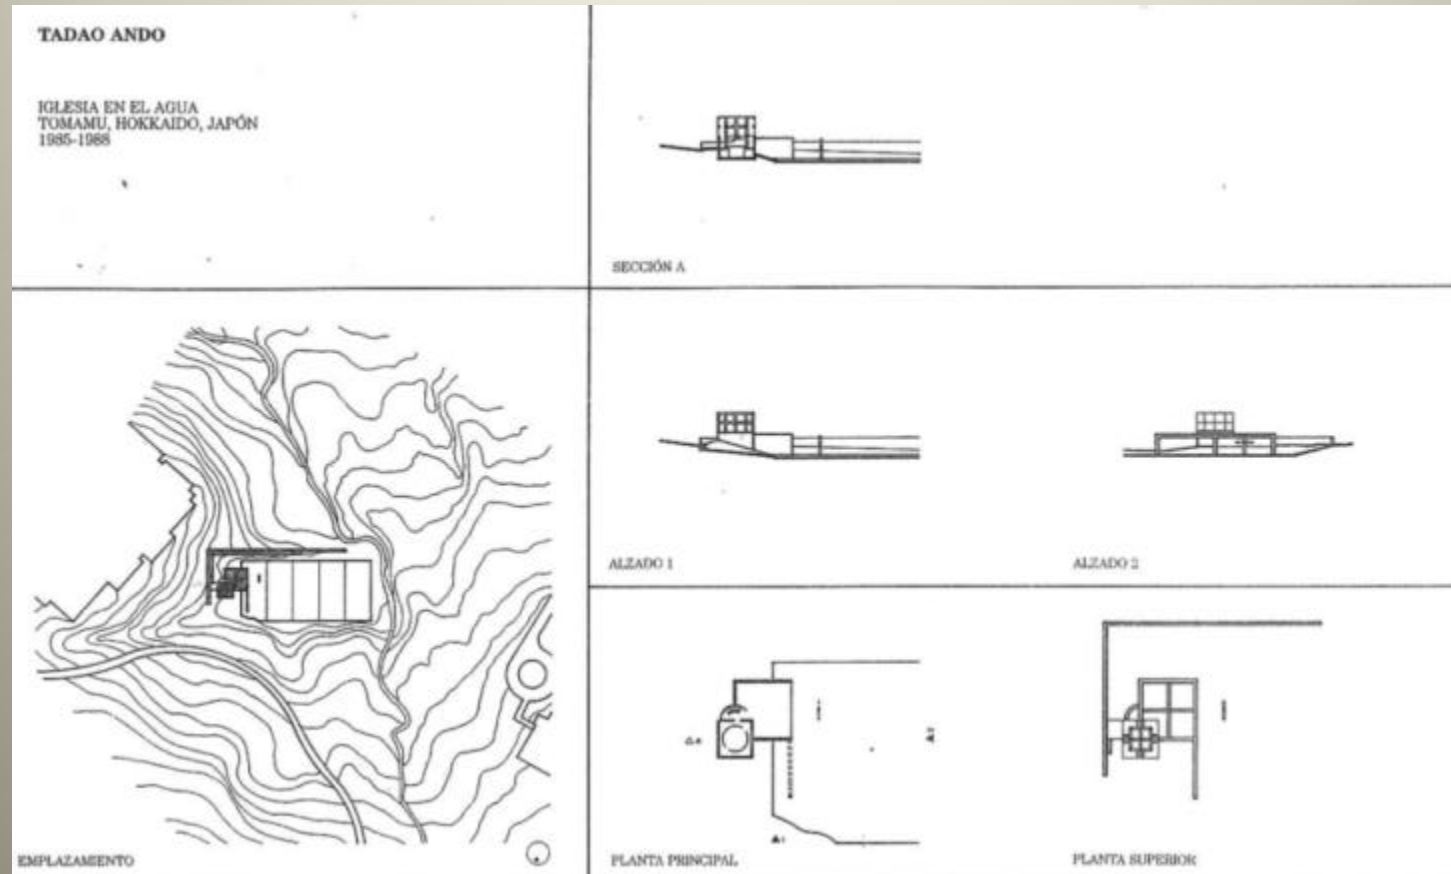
Implantação, Planta, Corte e Elevação - Igreja na Água (pág. 18)
